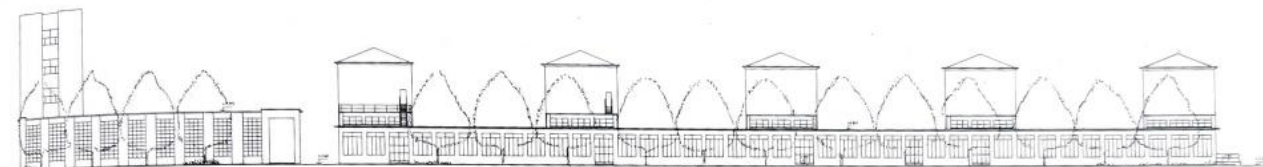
Prospetto ovest dell’edificio oggetto di studio pre-intervento di ampliamento [6]
